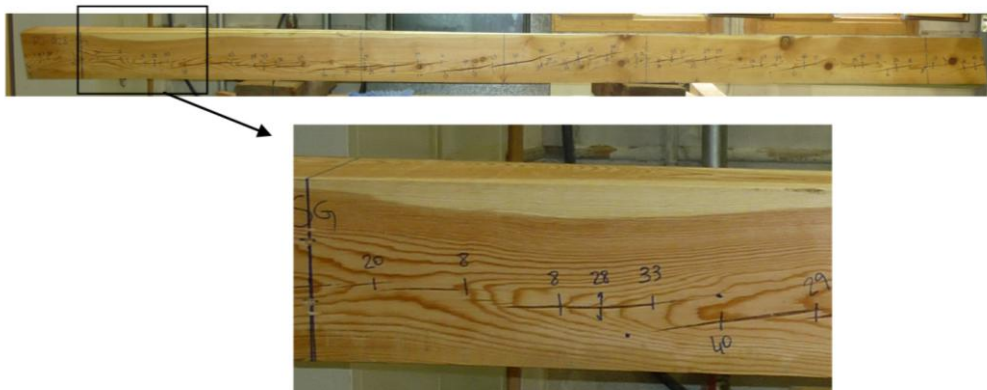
Pieza (entera y detalle) con fendas anotadas en la cara
